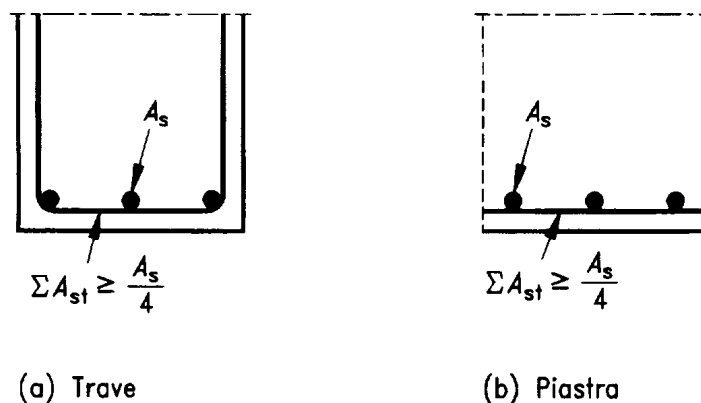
Armature trasversali nella zona di ancoraggio
